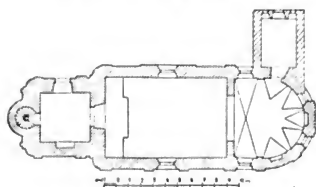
Zaleslitz. Grundriss der Kirche.
